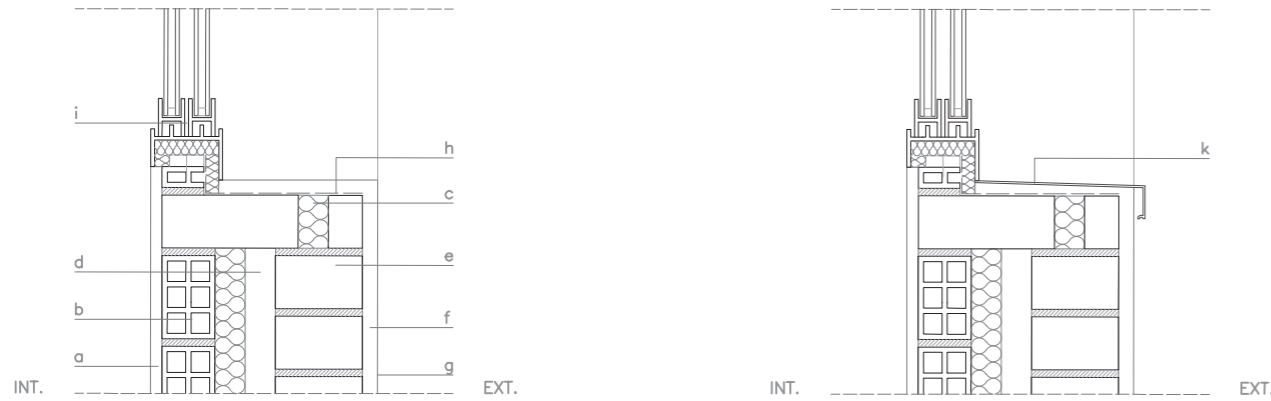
Detalle constructivo. Ventana tipo 3. Fachada principal. [Tabla 1]
